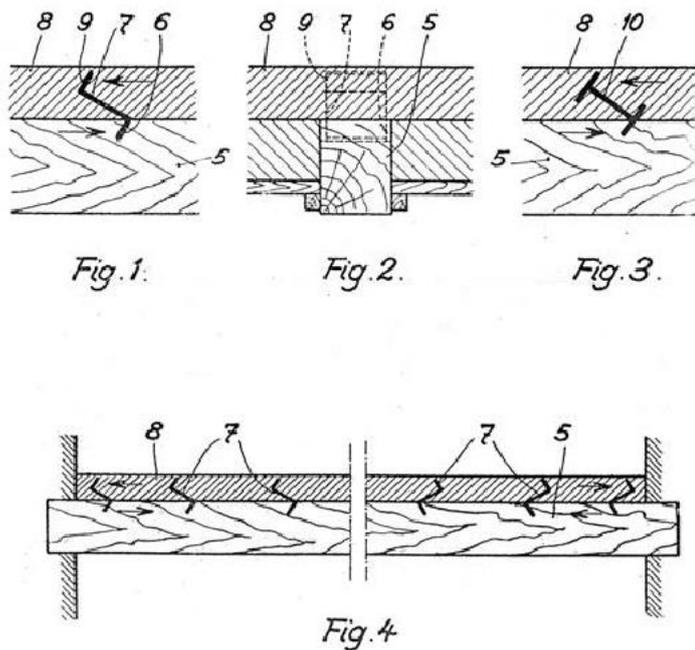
Holz-Beton-Verbunddecke nach Otto Schaub <sup>78</sup>
